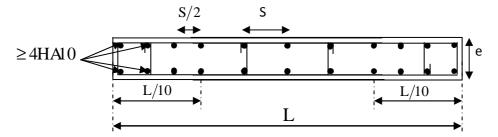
Disposition des armatures verticales dans les voiles.
